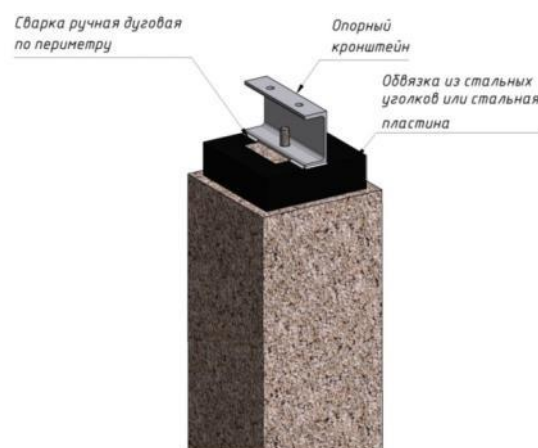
Крепление опорных кронштейнов при помощи сварки
